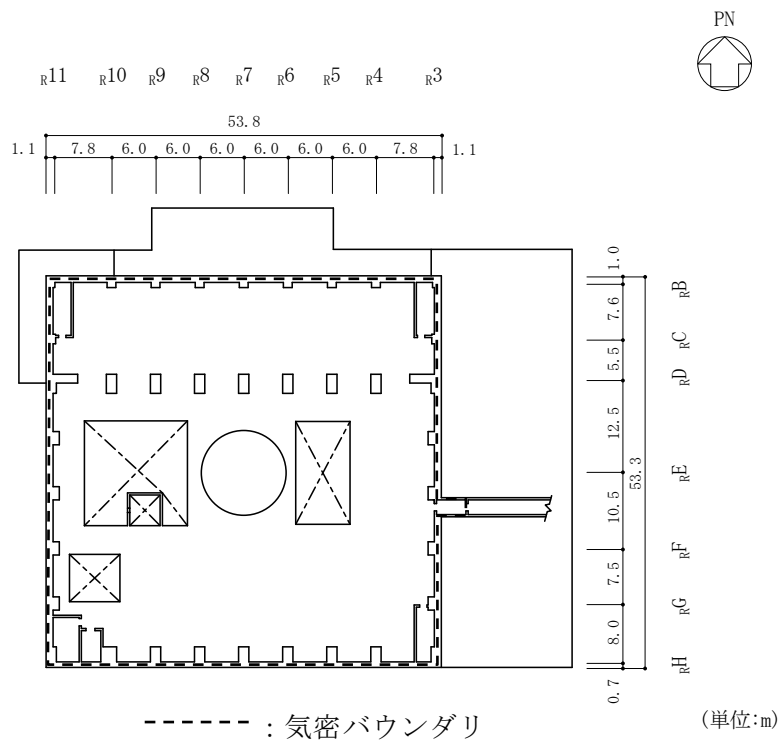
(7) 原子炉建物原子炉棟（二次格納施設）の概略平面図（EL 42.8m）
